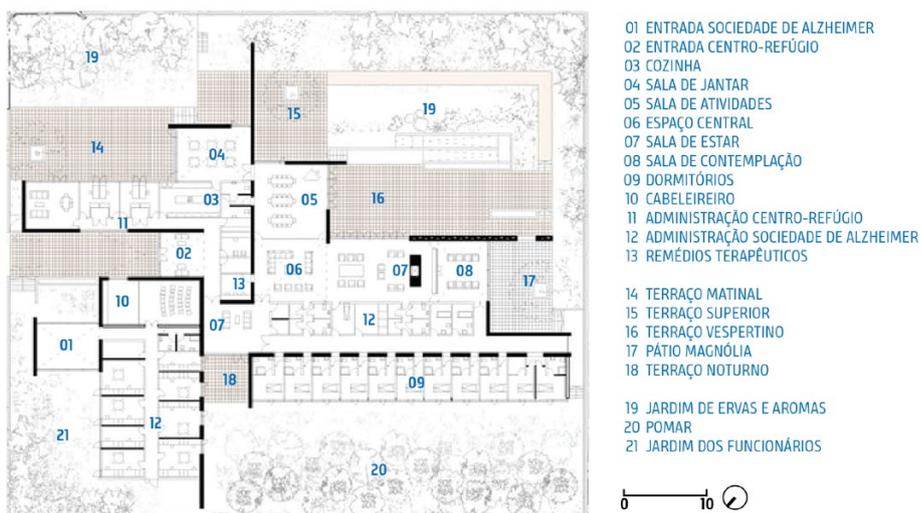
Planta baixa do pavimento terreno do Alzheimer's Respite Centre com indicações dos ambientes.
